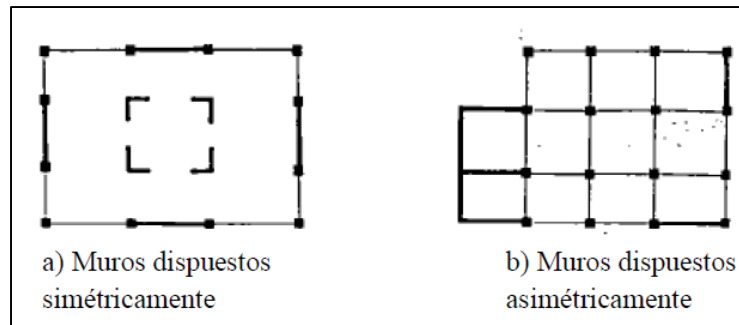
Distribución de los muros según su disposición en planta. Tomado de Fratelli (1999).
